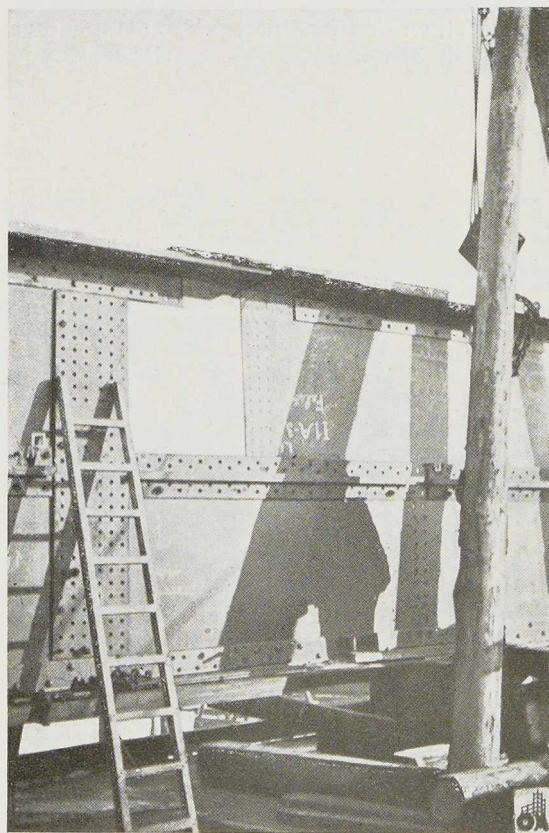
Assemblage des semelles supérieures et des raidisseurs horizontaux.
